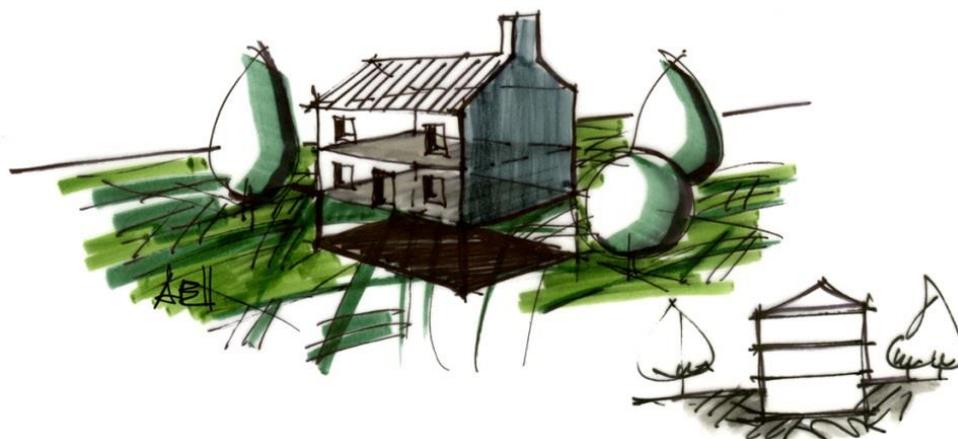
Cave completa (vista em perspectiva e corte)
